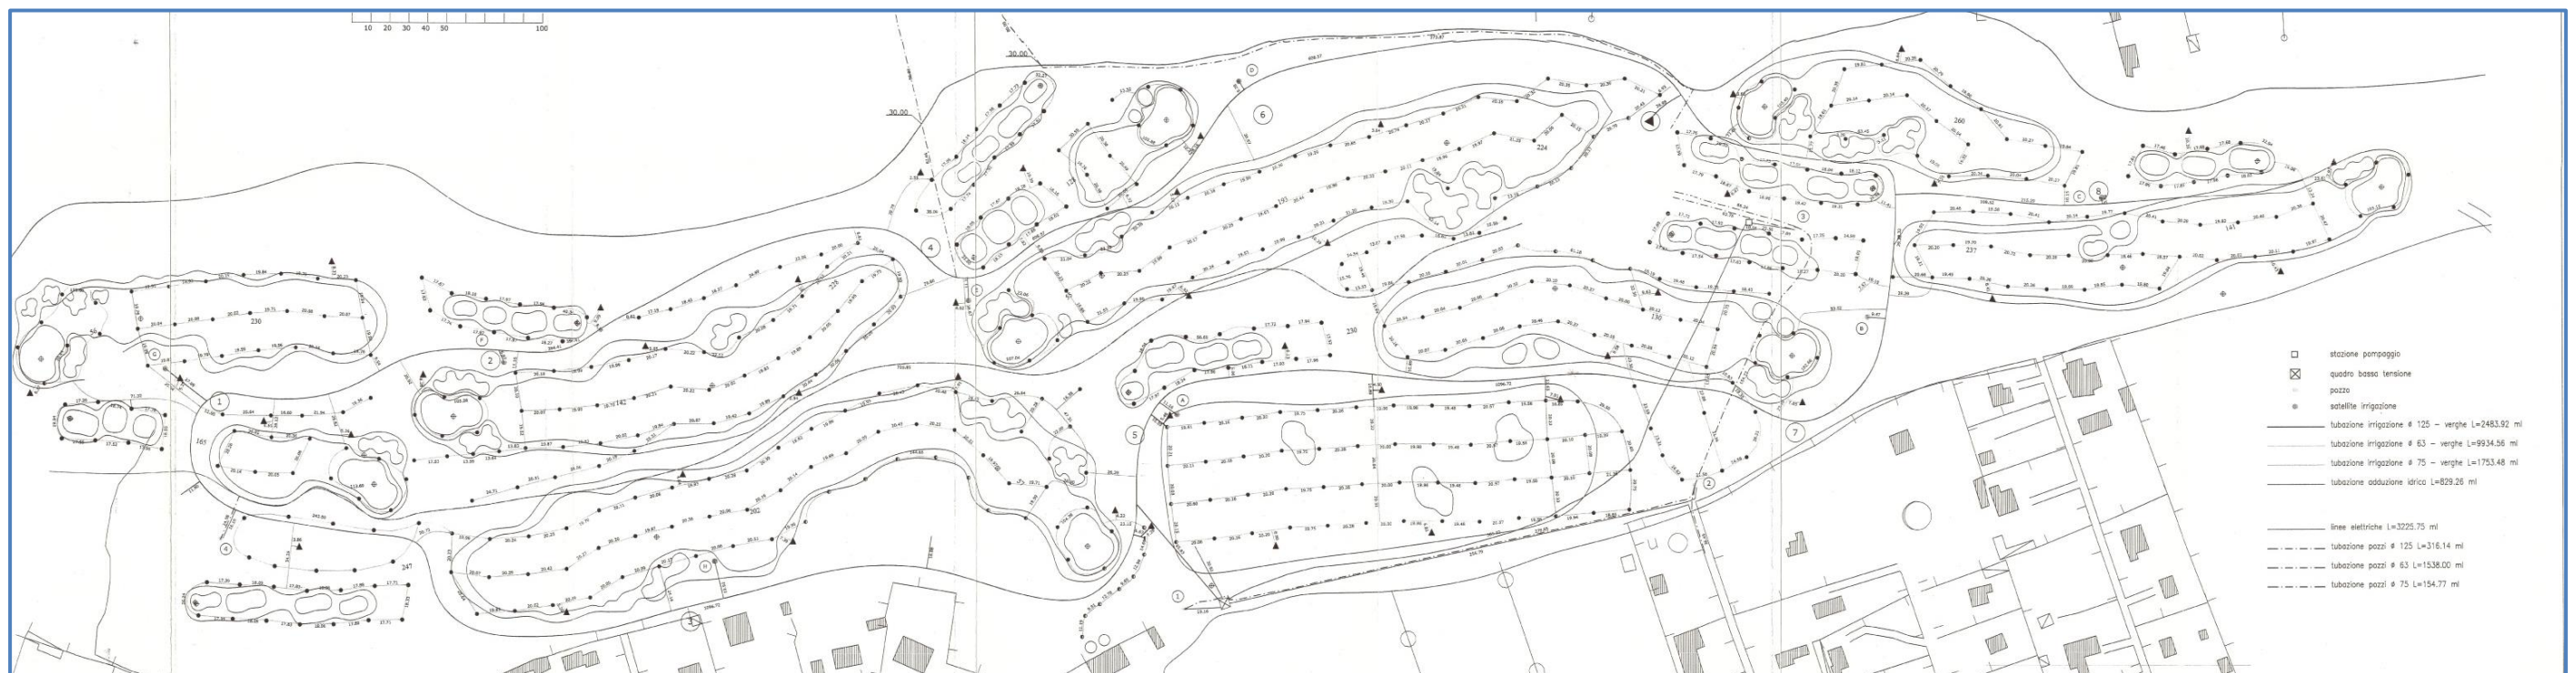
estratto della "Tav. n°22" del progetto dell'impianto di irrigazione del campo da golf (all. n°17)
